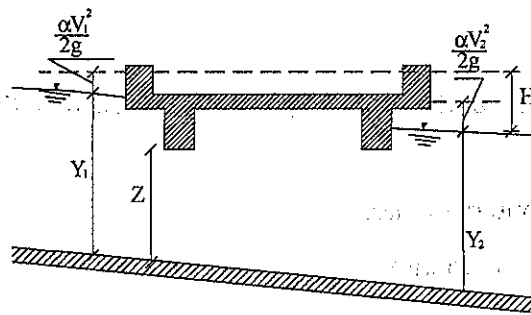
Sezione schematica di un ponte – Schema di calcolo
